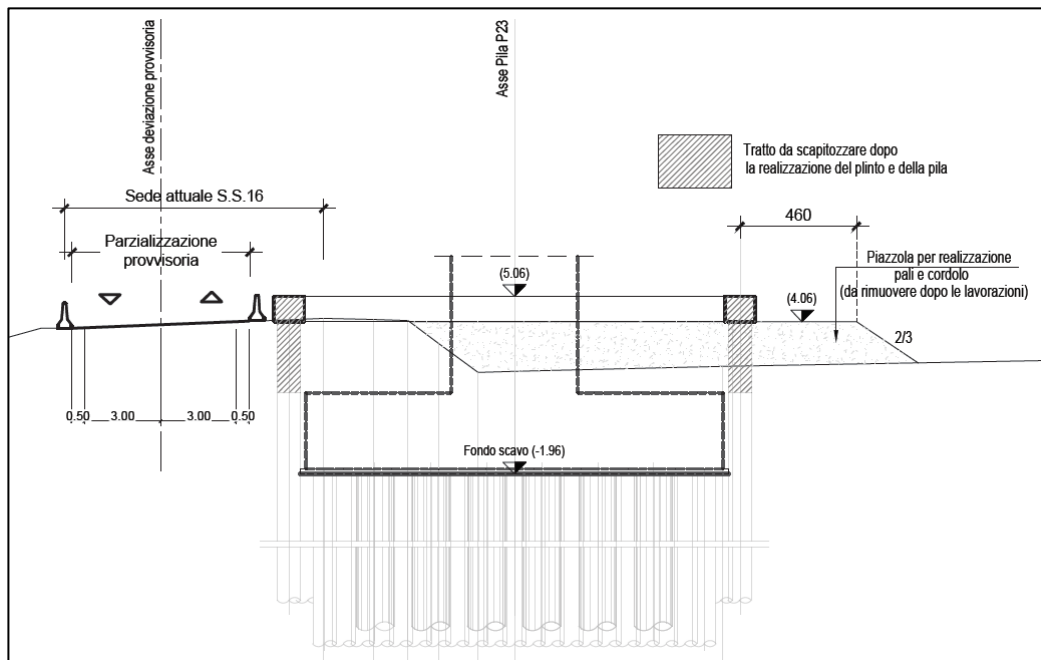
Sezione trasversale B-B in corrispondenza della pila P 23
